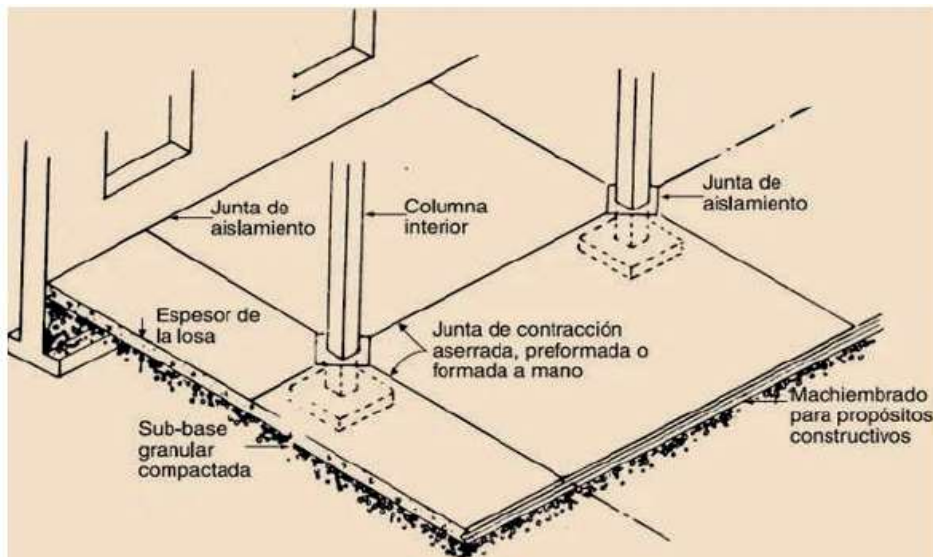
Tipos de juntas en pavimentos o pisos interiores.
